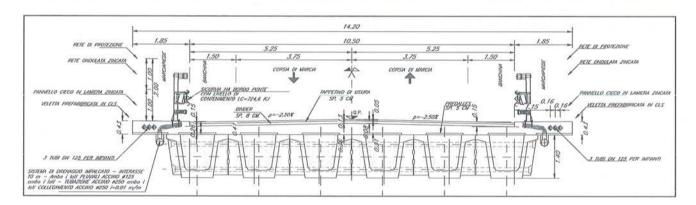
Sezione tipo cavalcaferrovia campata. L=25.00 m
